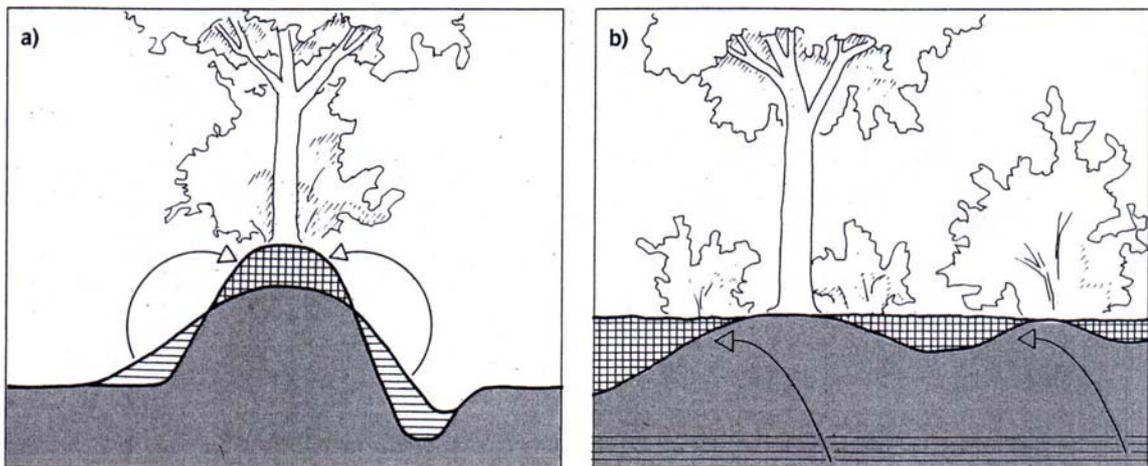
Instandsetzen eines Walkörpers a) Querschnitt, b) Seitenansicht
